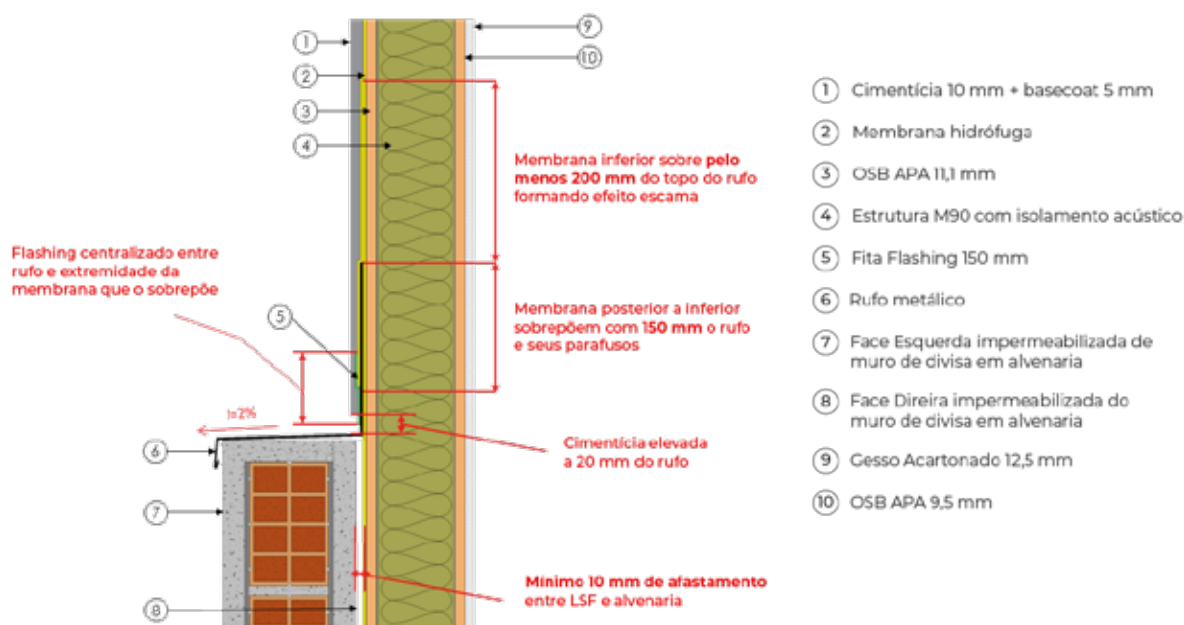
Seção Transversal de interface LSF e muro em alvenaria
